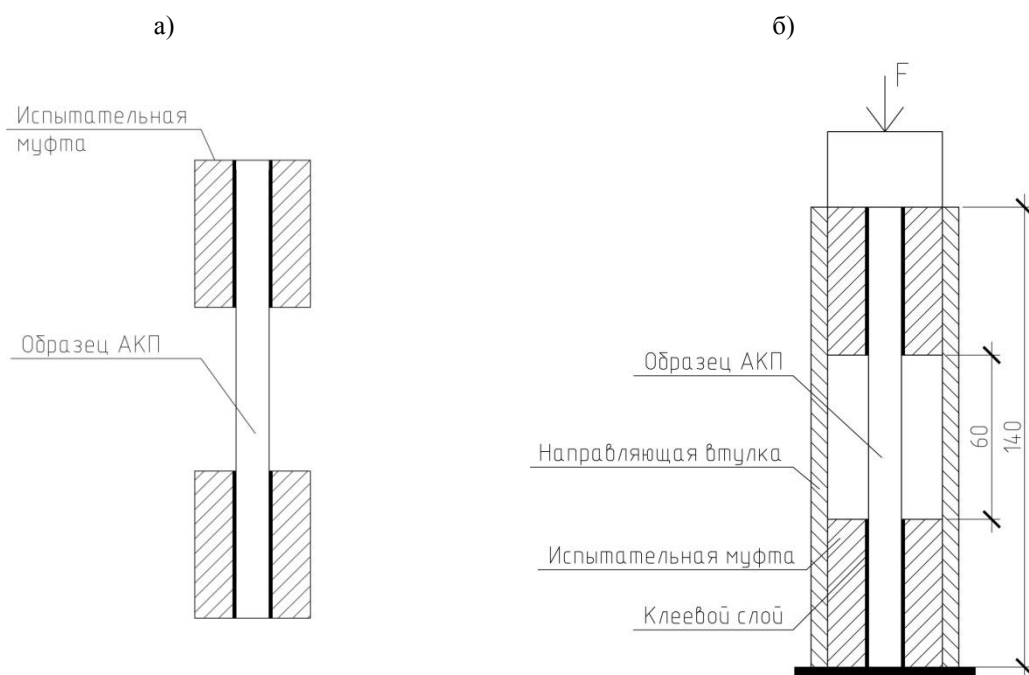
Схема испытания композитной арматуры на осевое сжатие:
